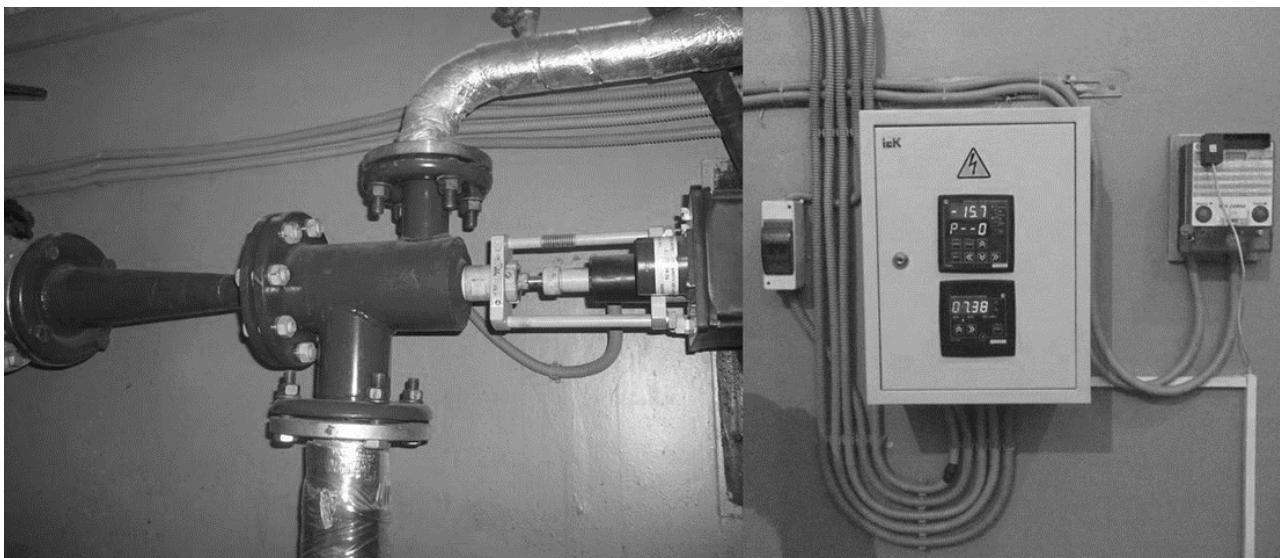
Внешний вид элеватора с регулирующим механизмом и контроллером
